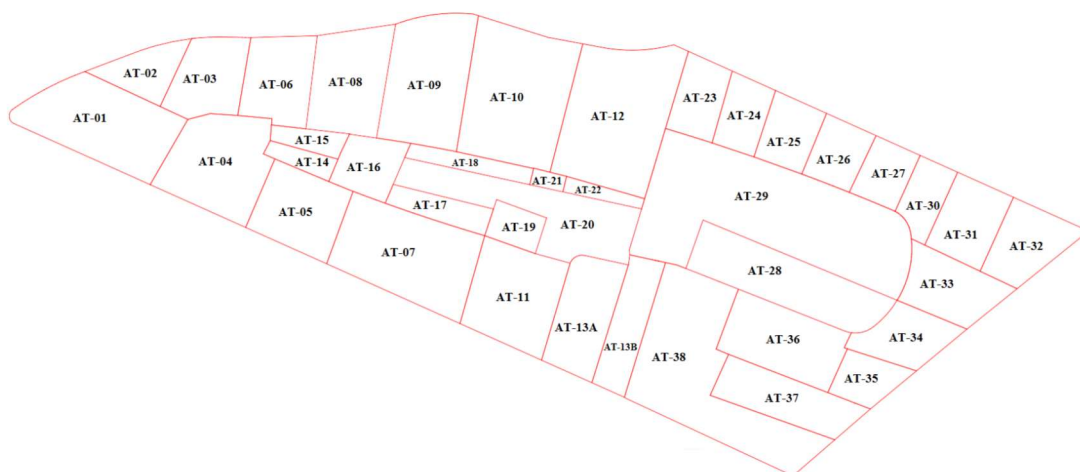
Planta da divisão da obra em áreas (FILHO, 2017)
